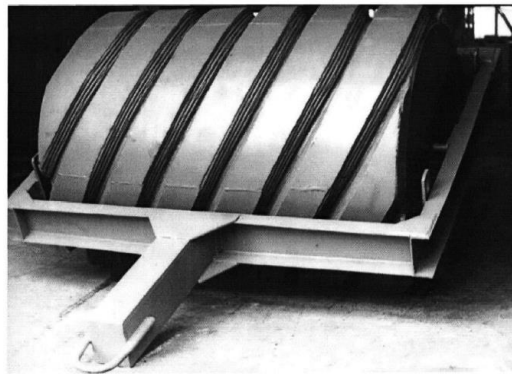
Прицепной валец катка покрытый гибкой лентой (металлическим тросом) для изменения жесткости обечайки
